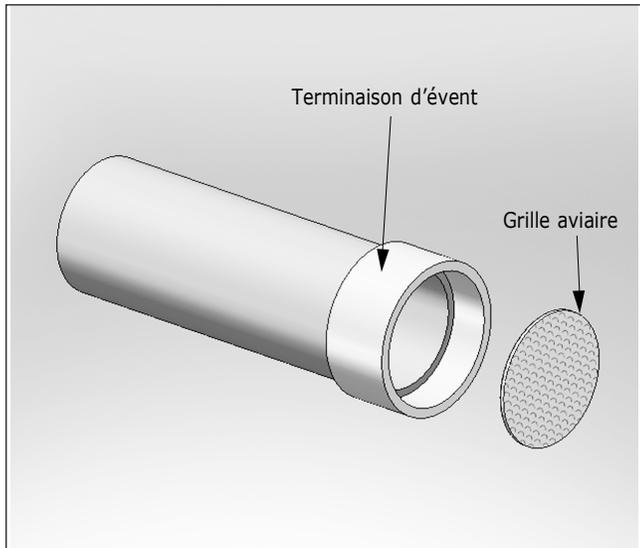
Installation de grille aviaire sur tuyauterie d'évent murale
